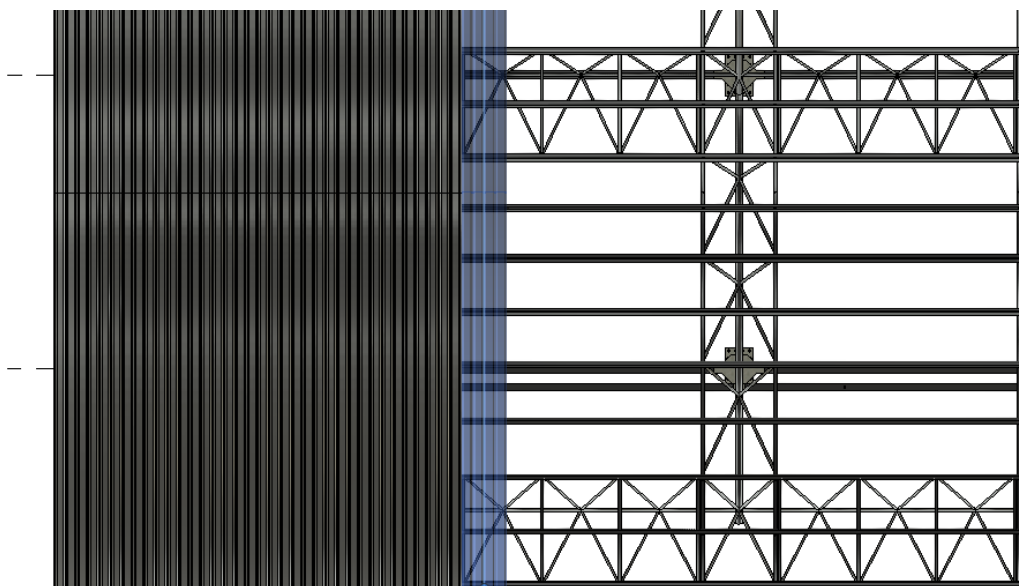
Vista en planta Multytecho (elaboración propia).
